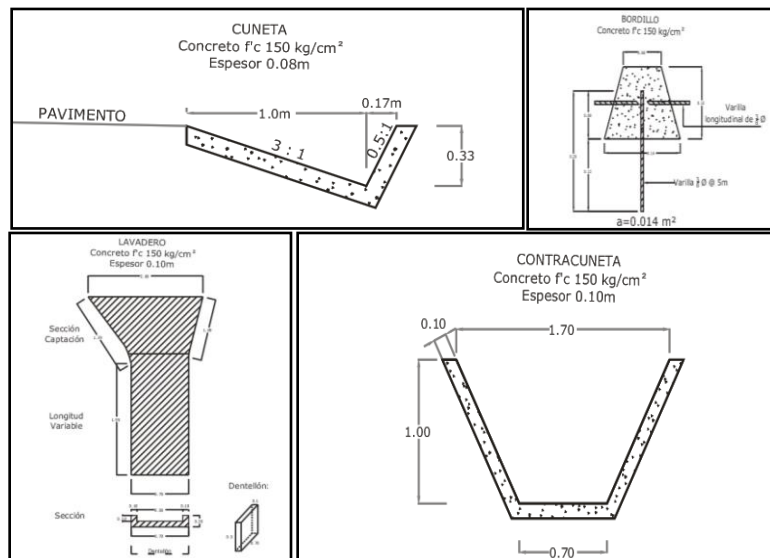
Sección tipo de las obras de drenaje complementarias.
